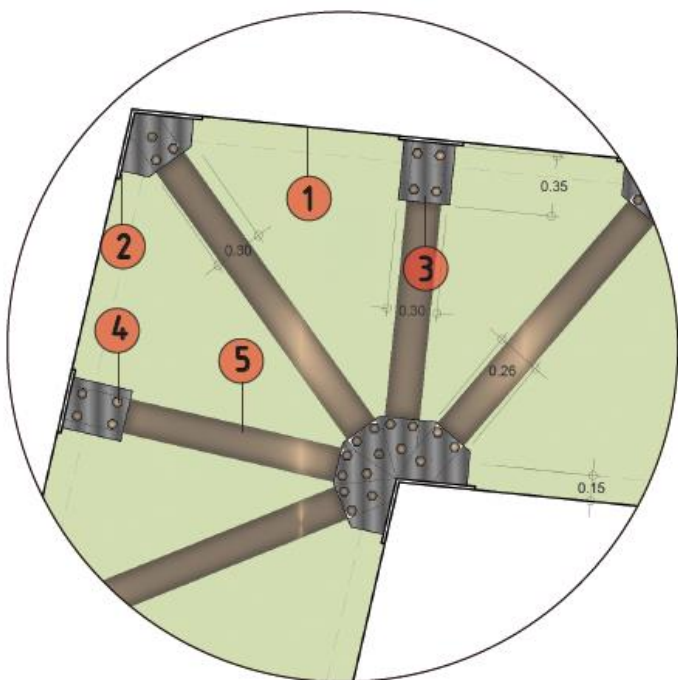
Detalle de cercha estructural, predeterminada por cálculo estructural. Elaboración propia.
